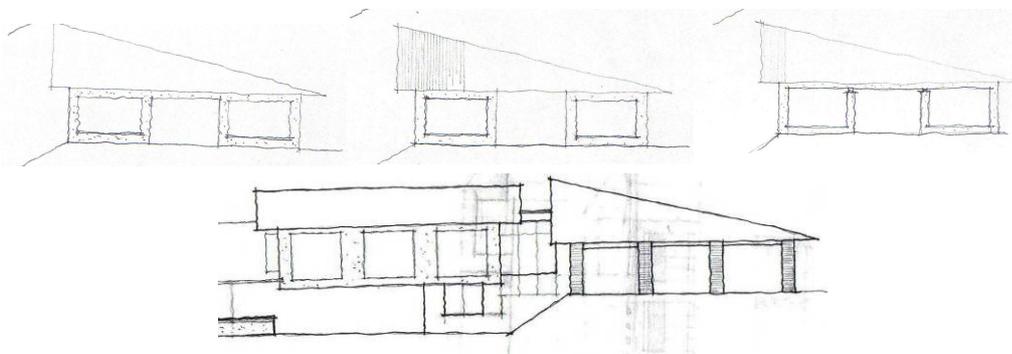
Croquis da concepção de efeitos figurativos nas fachadas
